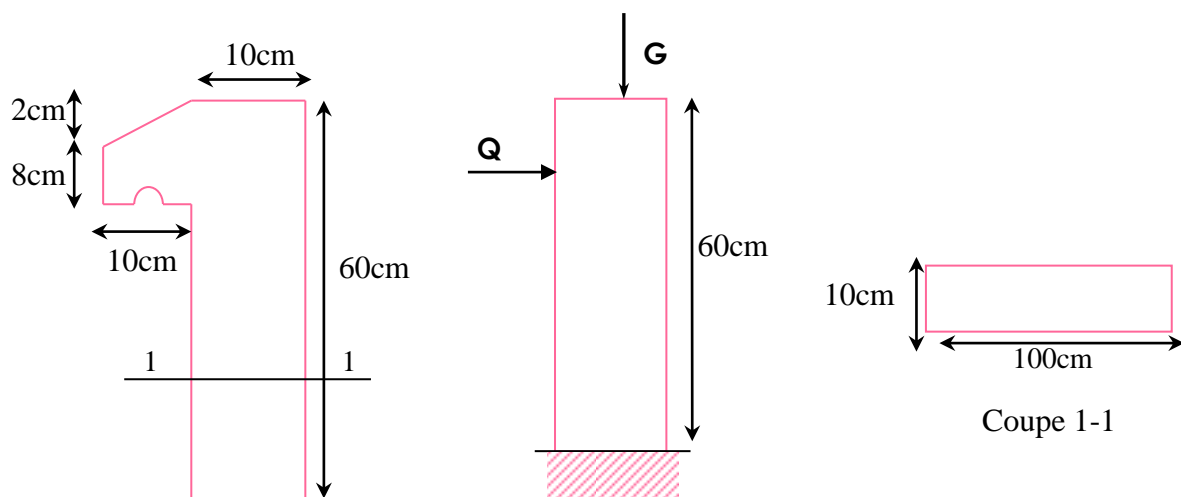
Coupe transversale et longitudinale de l'acrotère.
